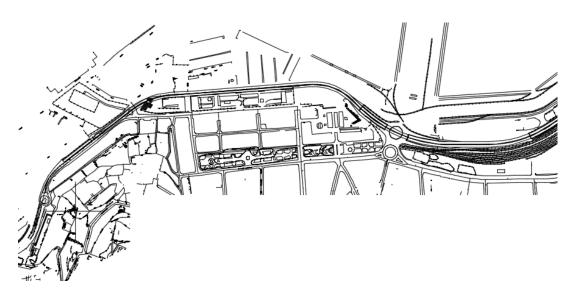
Plano trazado túnel. Fuente: AutoCAD
